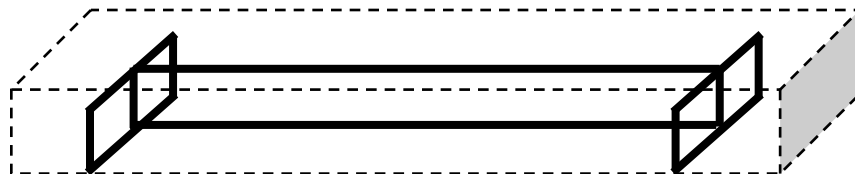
Detalle de armado transversal de hierro para cimentación
